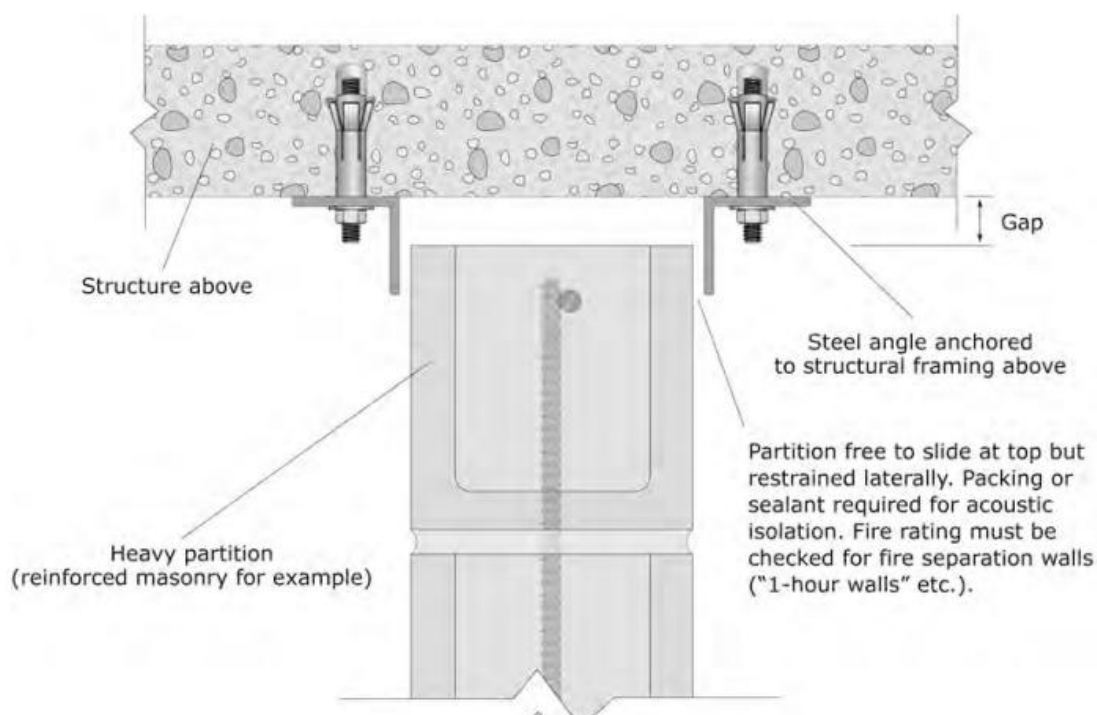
Ancoragem da parede à viga, utilizando ângulo metálico. Adaptado de [11]
